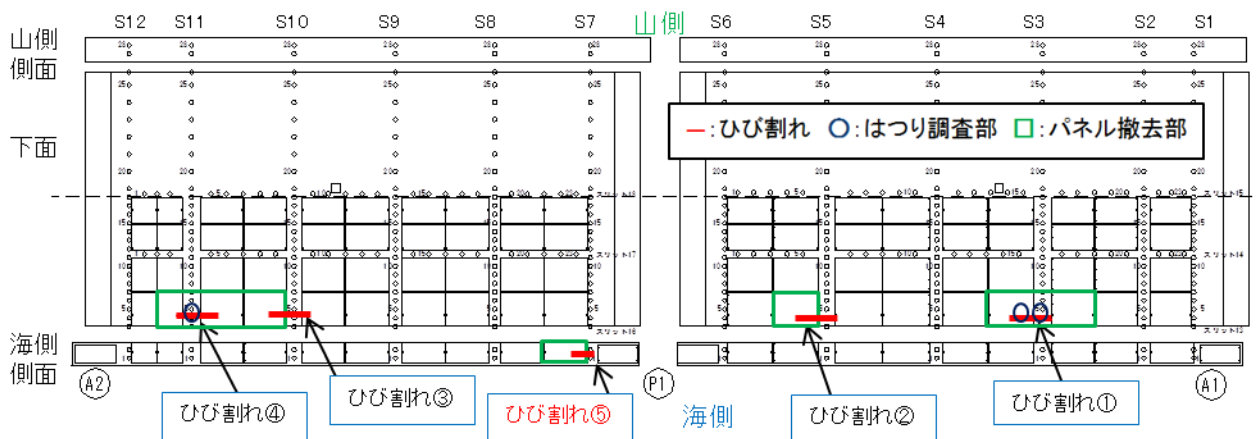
アルミパネル配置図およびひび割れ箇所
